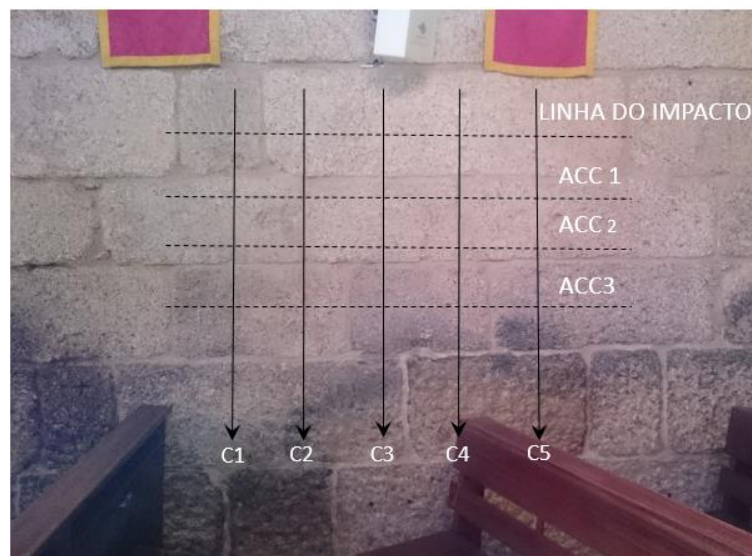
Configuração do ensaio indireto da parede sul da nave.
